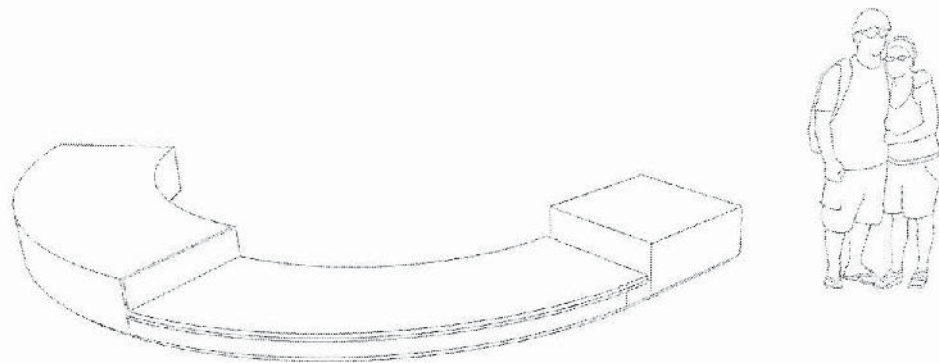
DETALLE DE BASE DE PLACA DPV
